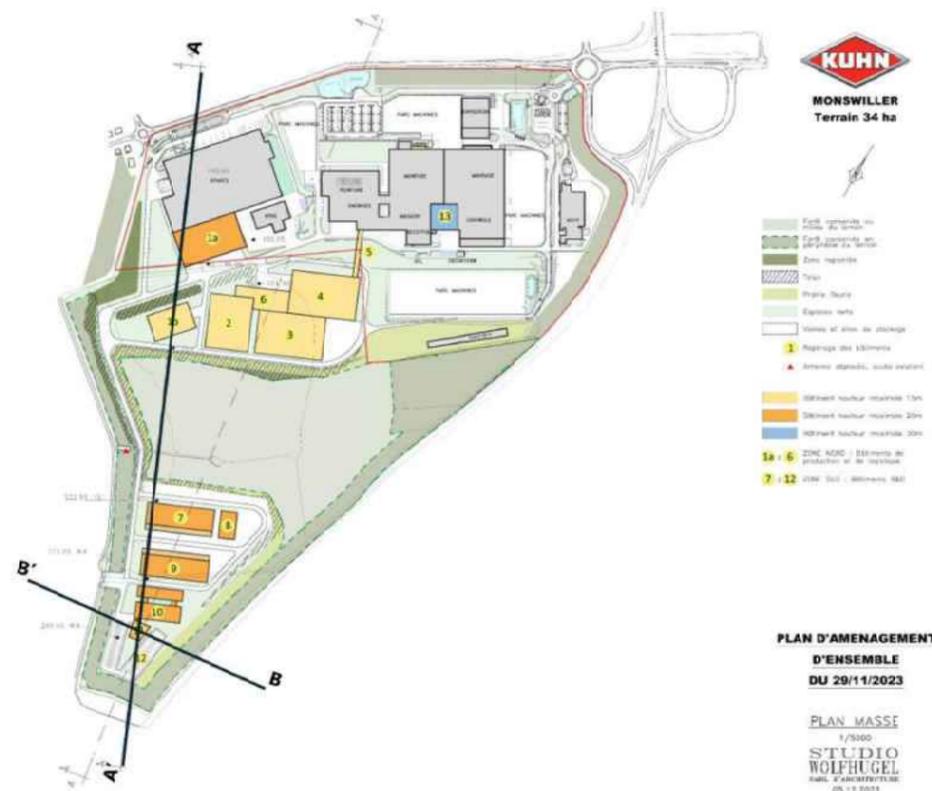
PLAN MASSE DU PROJET (SOURCE : STUDIO WOLFUGEL)
